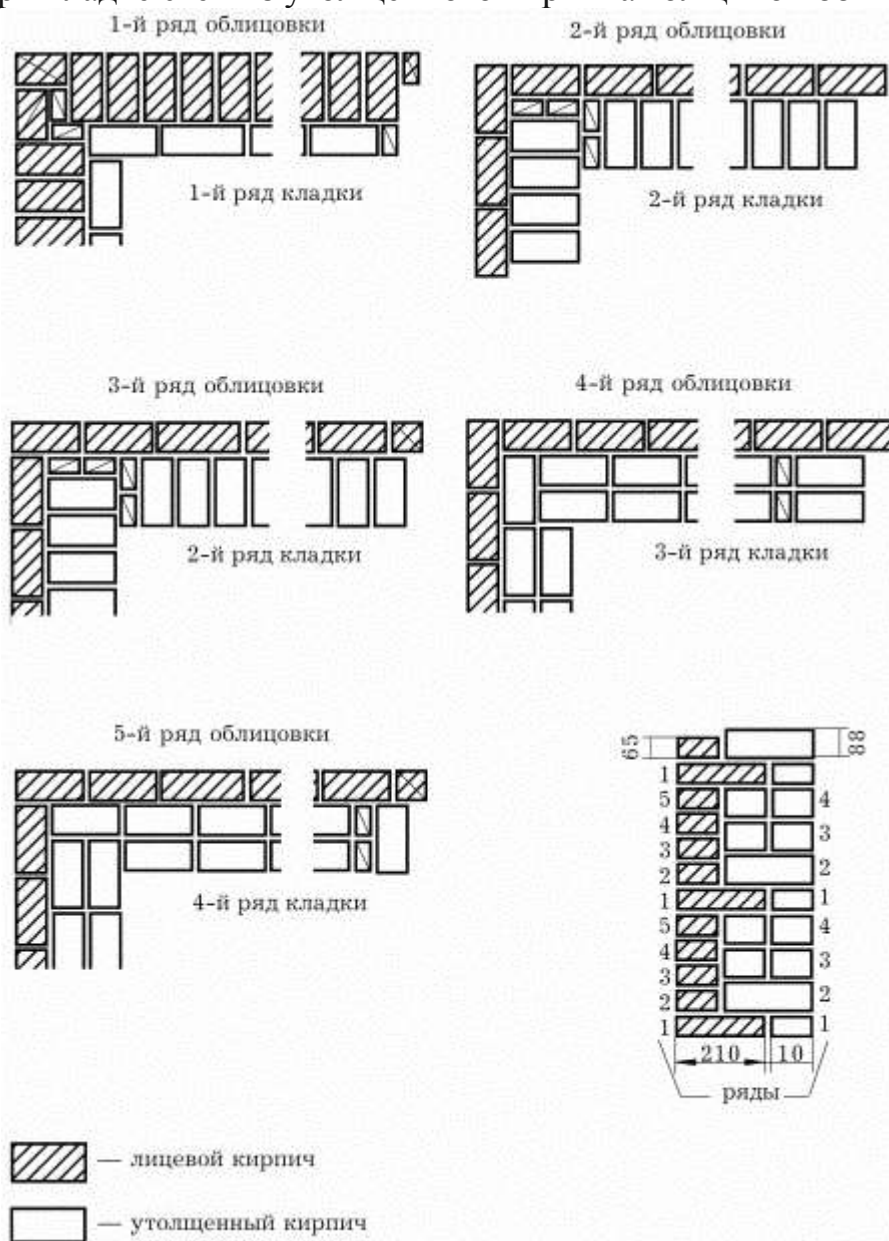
Перевязка кладки из кирпича толщиной 88 мм с облицовкой
